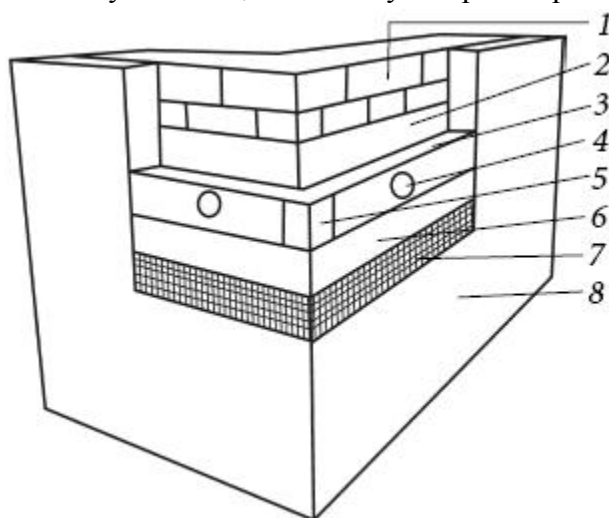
Система «мокрого фасада»: 1) подготовленная поверхность стены; 2) клеевой состав; 3) плиты утеплителя; 4) крепежи (дюбели); 5) металлический уголок в месте пересечения стен; 6) клеевой состав под армирующую сетку; 7) армирующая сетка; 8) декоративная штукатурка
